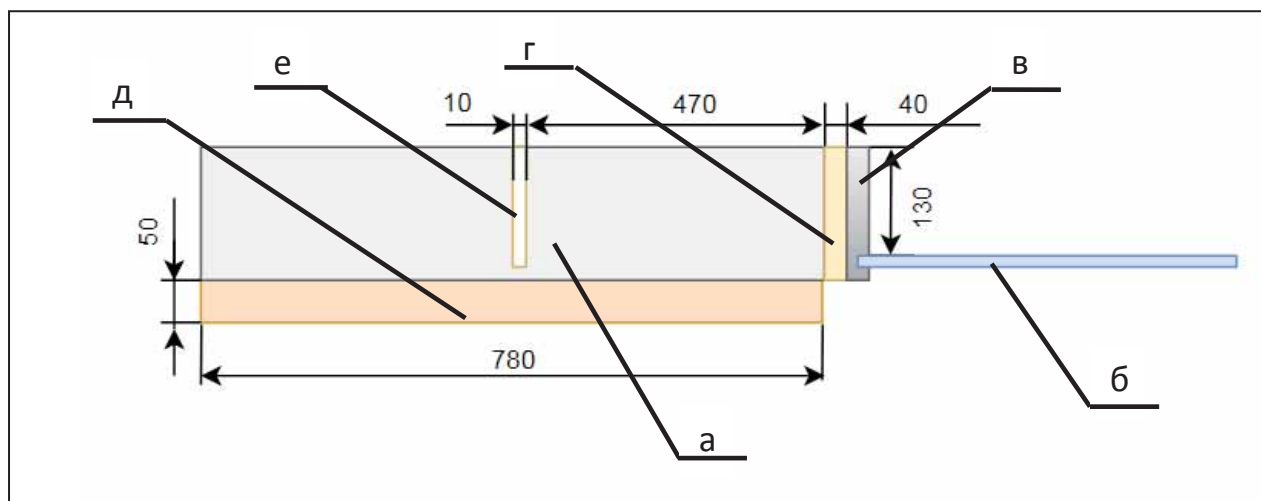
Схема узла исследуемого фрагмента. Дефект кладки прямоугольной формы, толщиной 10 мм, высота 140 мм, глубина 190 мм., утепление наружной поверхности стены 50 мм: а – стена; б – стеклопакет; в - оконный профиль; г - пенный шов; д – утеплитель.
